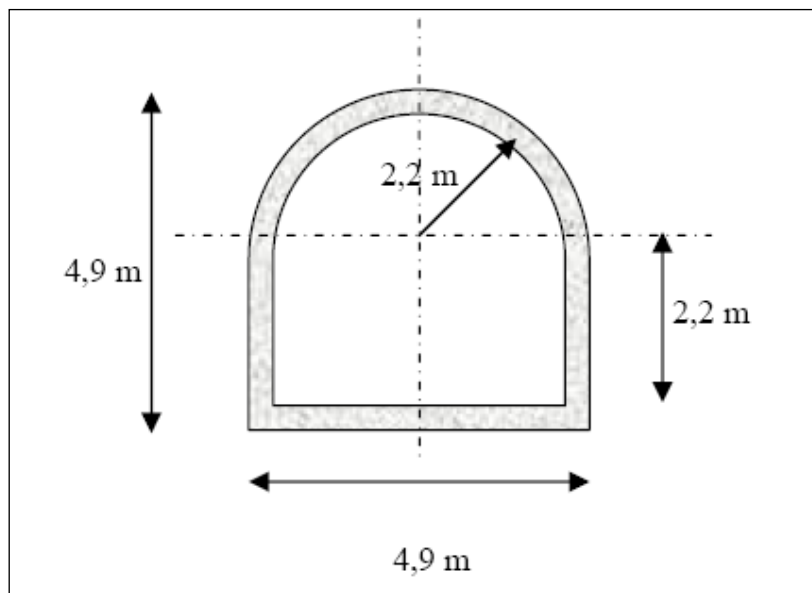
Sección tipo, tramo aguas arriba de la Caverna de Válvulas. Fuente: proyecto construcción Embalse de Chacrillas.
